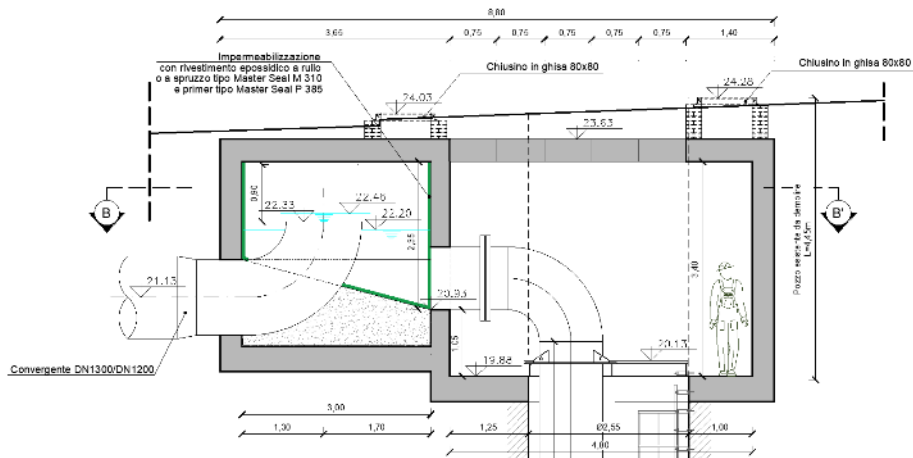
Immissione della premente B nel "pozzo 8" – Dettaglio delle camere di sbocco
